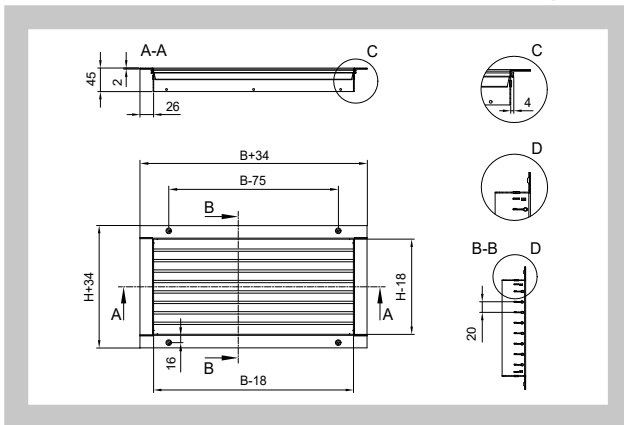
Einstellbare Lamellen horizontal - einreihig B > 750 mm
